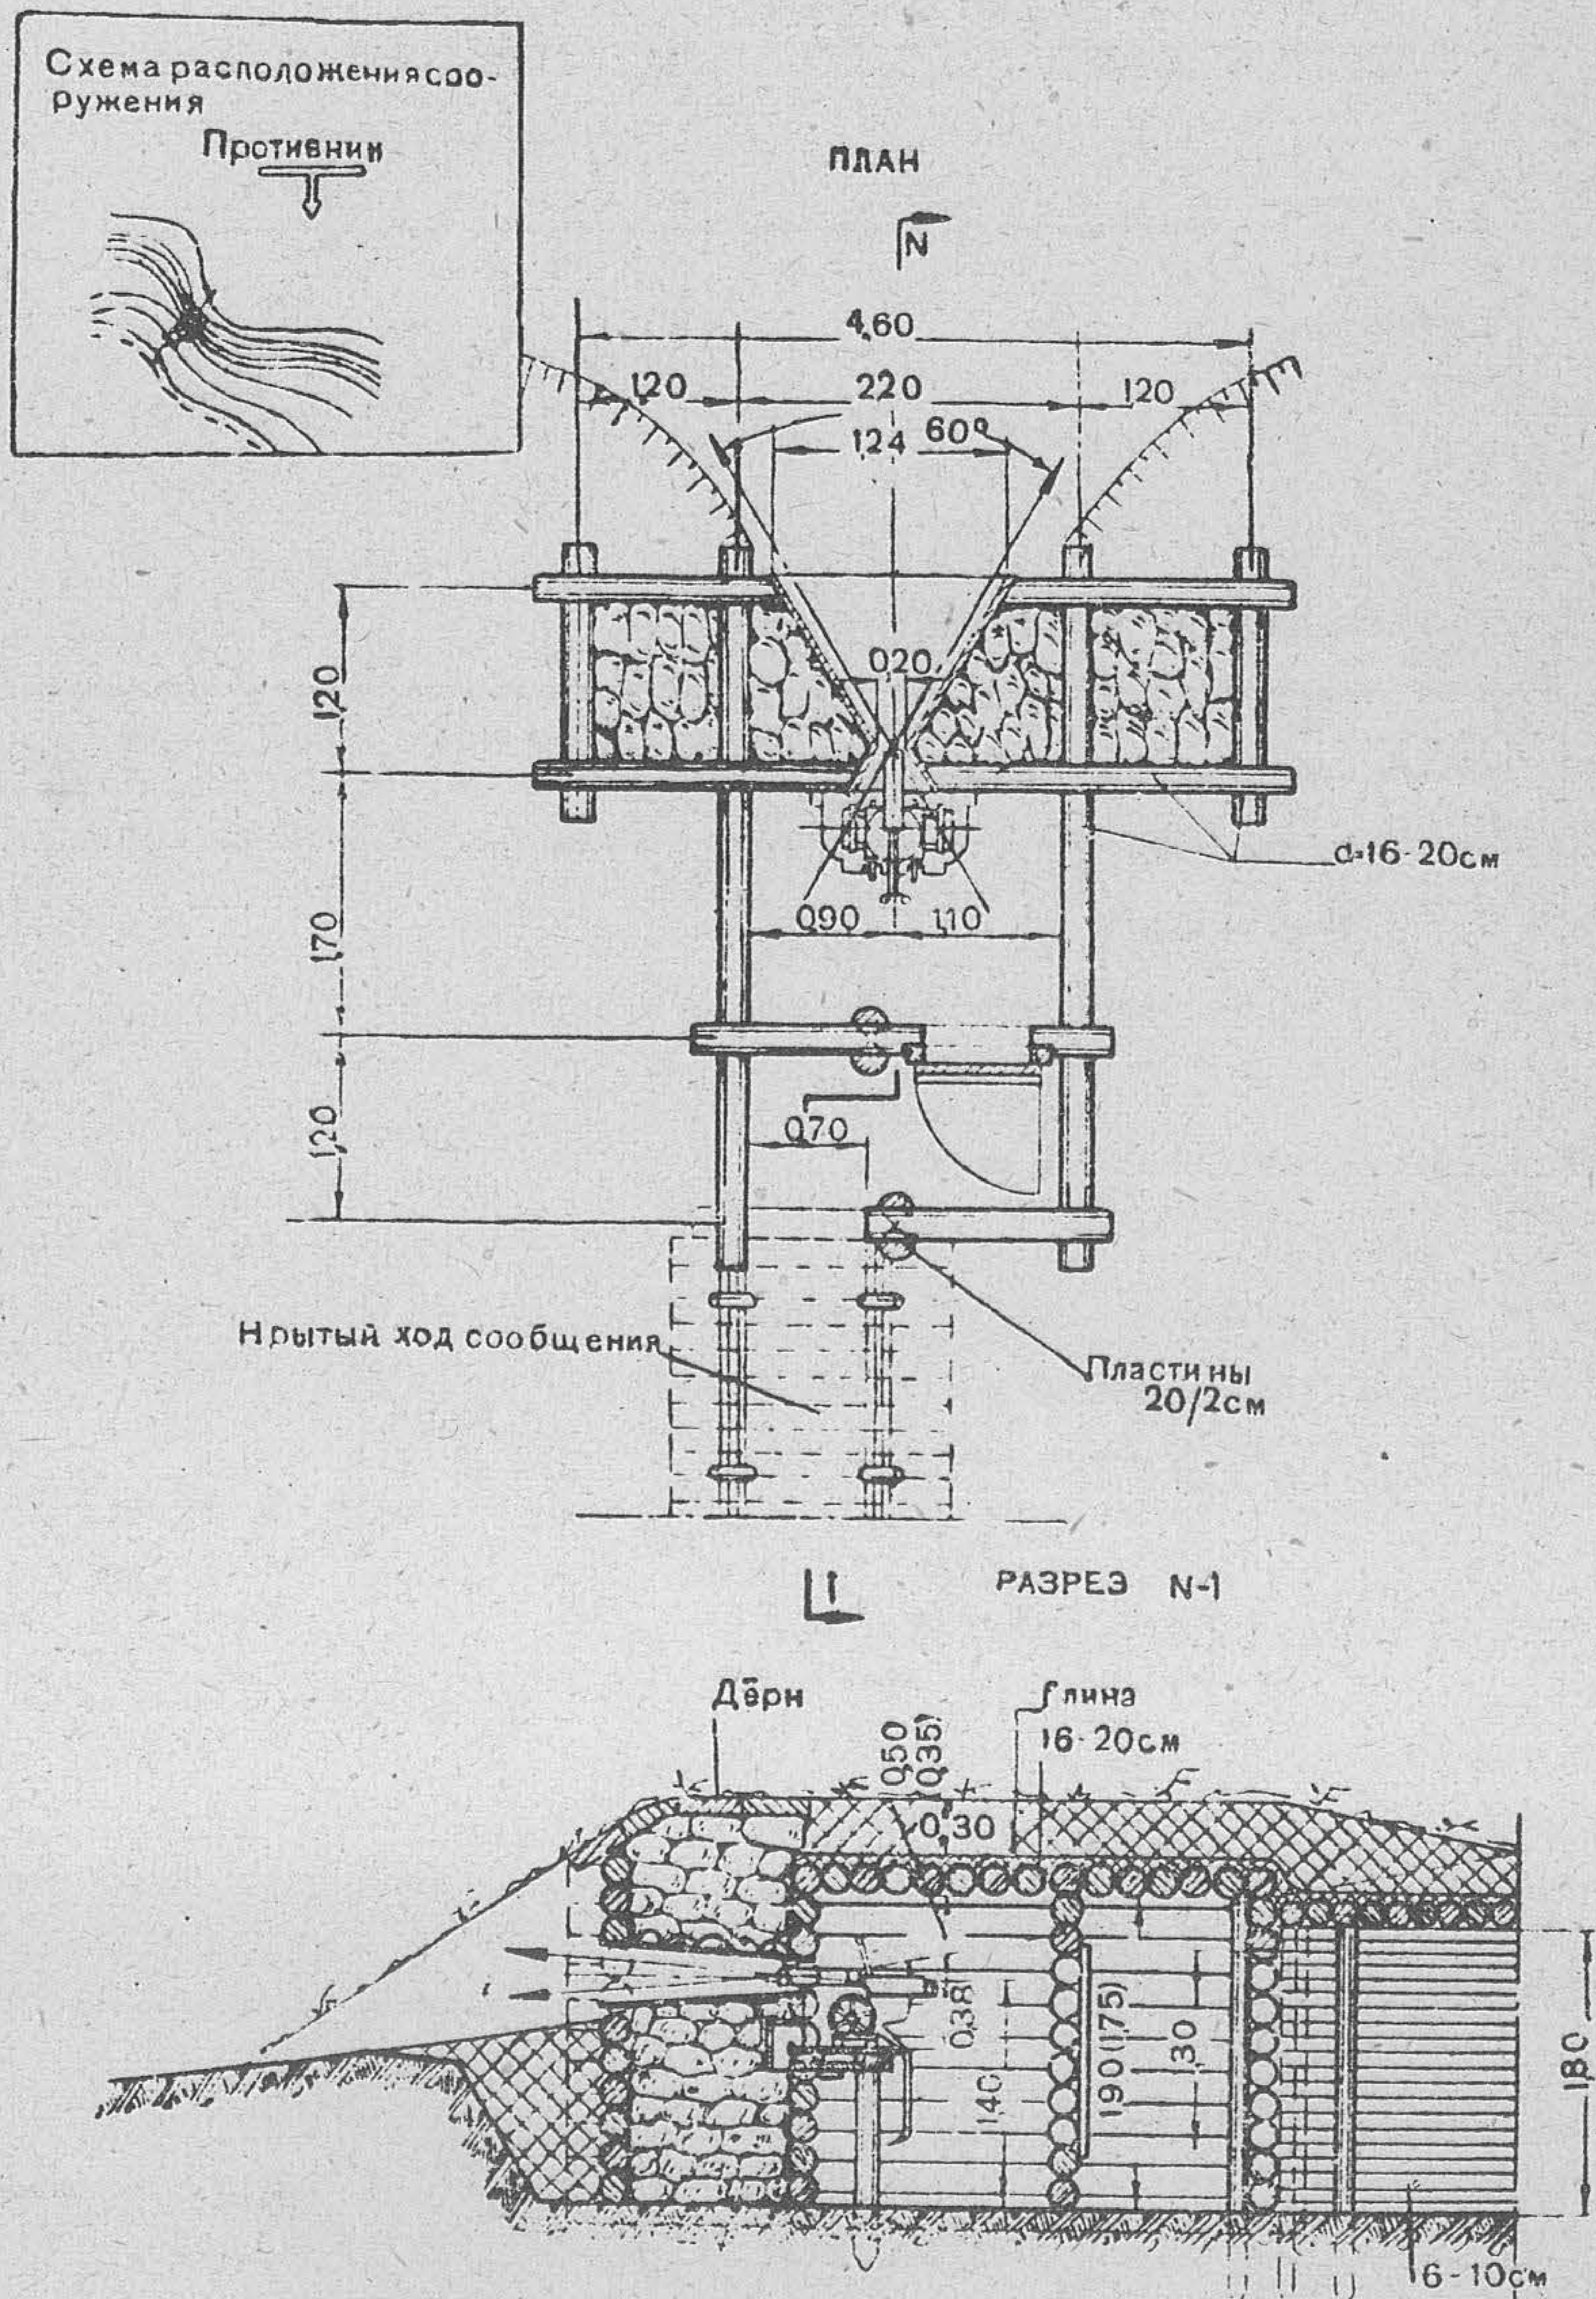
Дерево-земляное казематированное пулемётное сооружение (фронтальное) с усиленными стенами и с покрытием лёгкого типа
